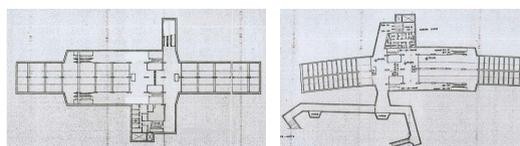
Planta da Estação São Judas; Imagem 2: Planta da Estação Conceição
